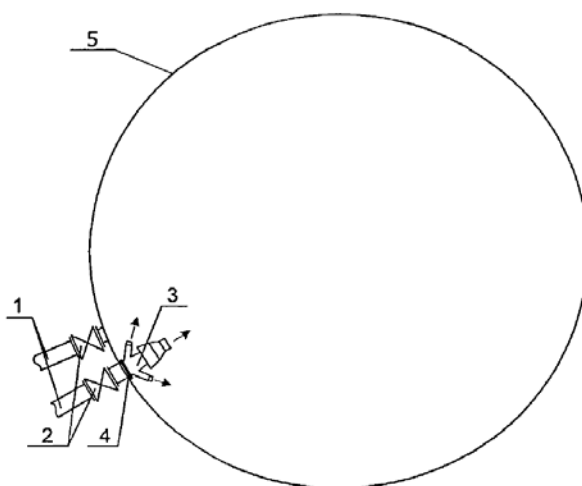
Схема установки СГС в резервуаре (1 – приемо-раздаточный патрубков; 2 – задвижка; 3 – струйный гидравлический смеситель СГС; 4 – фланец для установки СГС; 5 – резервуар)
